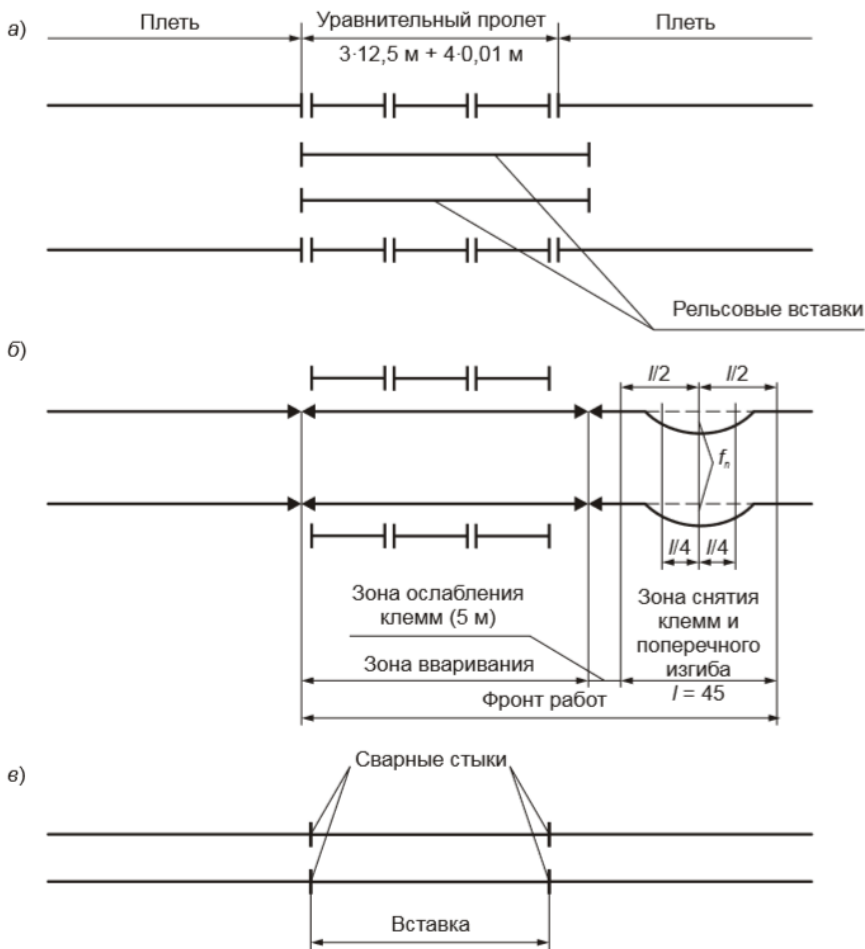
Схема фронта работ и последовательность операций при создании длинных рельсовых плетей в процессе эксплуатации: а – схема уравнительного пролета с подготовленными к сварке рельсовыми вставками; б – схема разметки места сварочных работ; в – состояние участка после окончания работ
